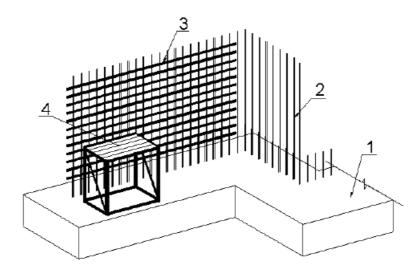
Армирование верхней части подпорной стены горизонтальными отдельными стержнями
